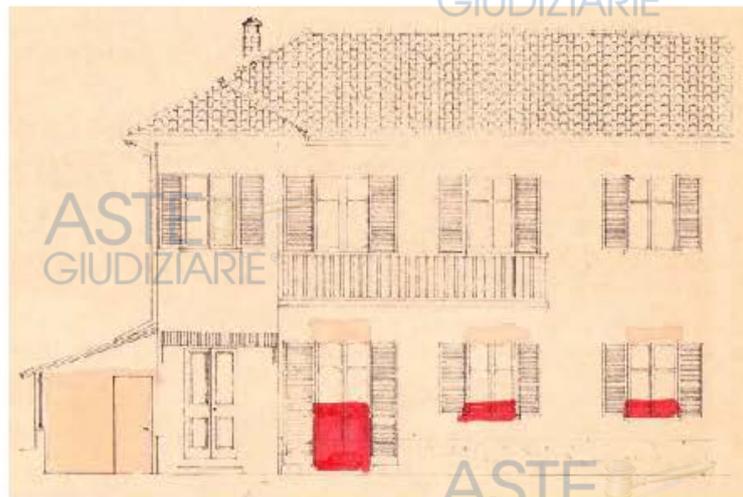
Estratto situazione autorizzata con Autorizzazione 79 del 23/01/1992 – prospetto su fronte
